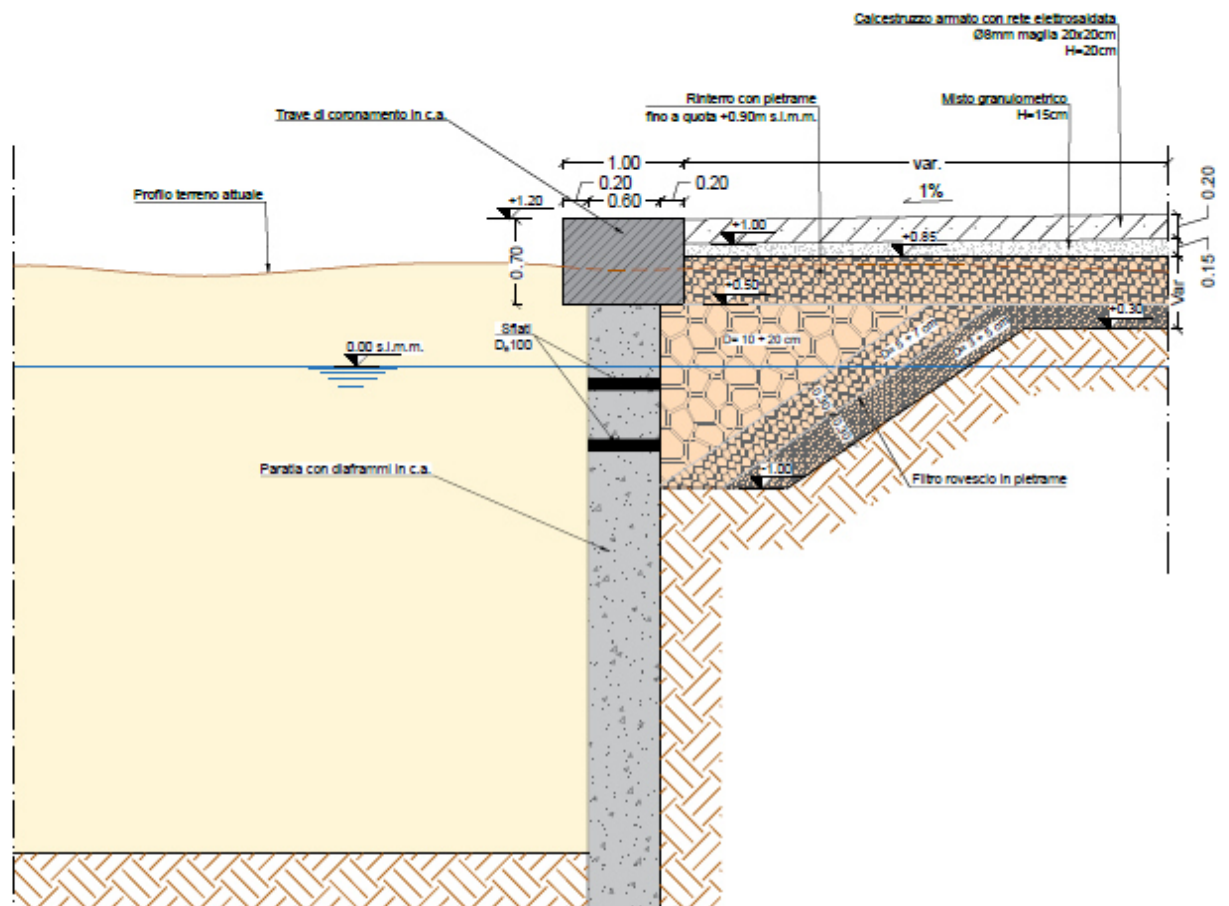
Sezione tipo banchina con paratia realizzata in diaframmi, nella fase antecedente il dragaggio e nella fase successiva al dragaggio Fig 14
